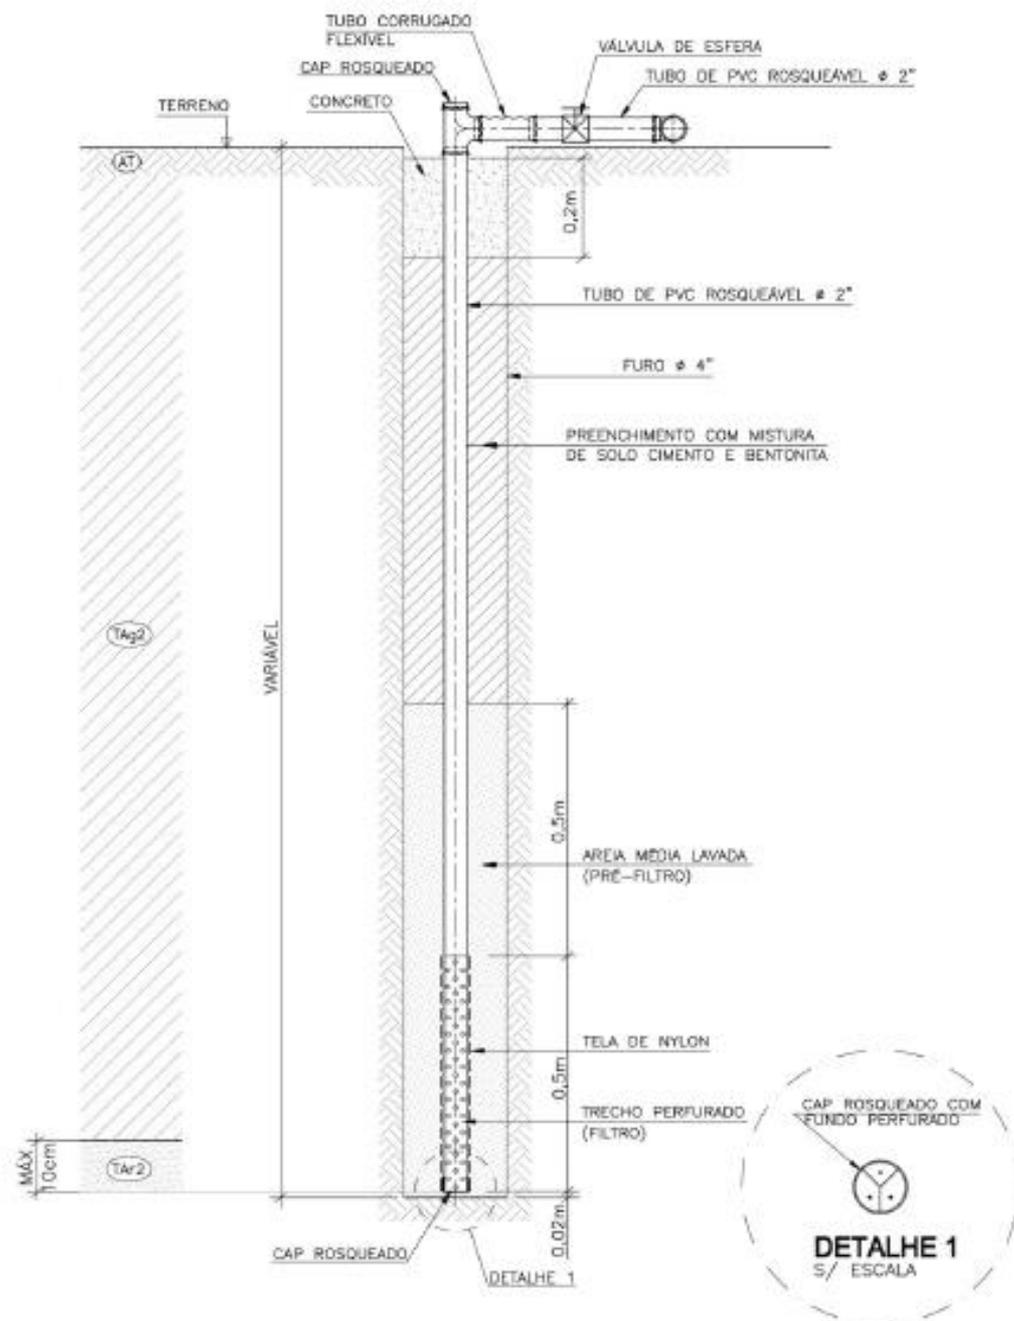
Perfil típico de instalação dos poços de extração e ventilação.
